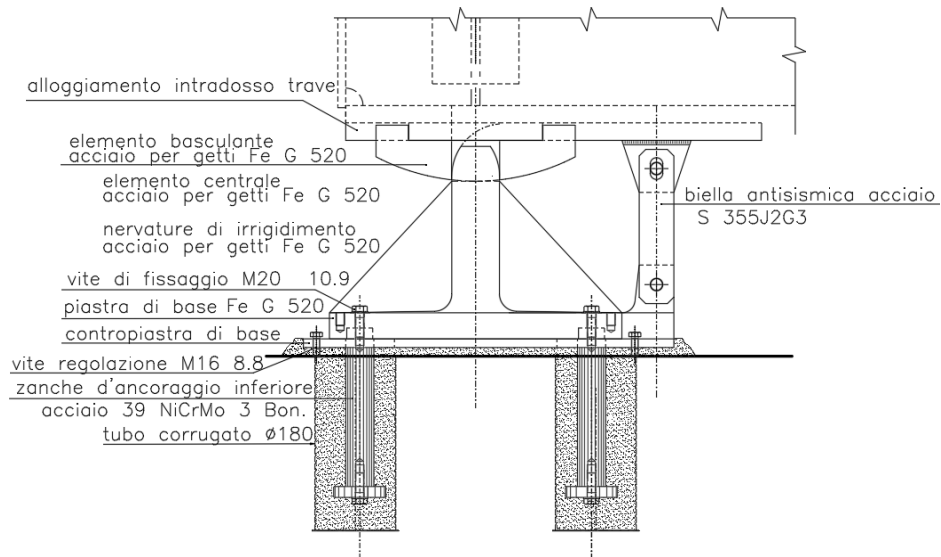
Sezione longitudinale dispositivi di appoggio fisso
